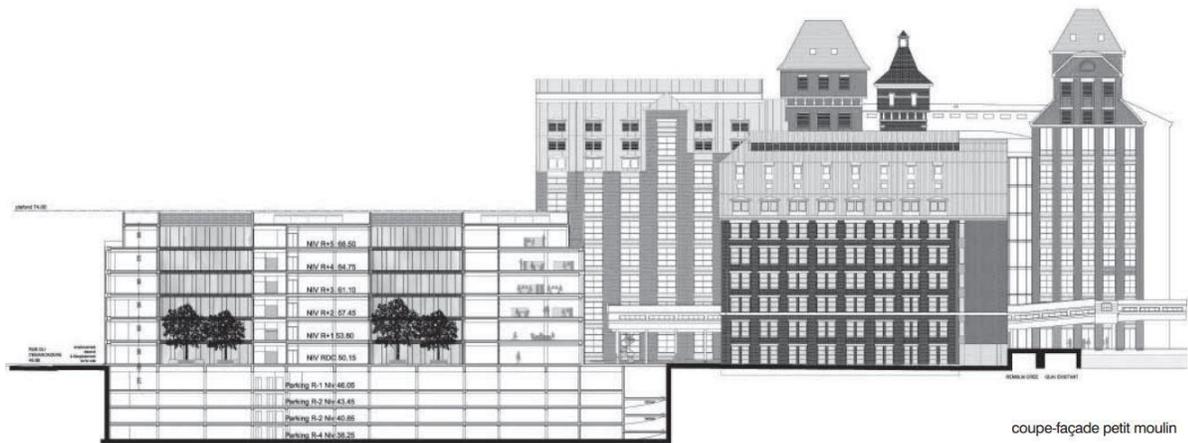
Coupe façade(AA) du petit Moulin avec en arrière-plan les façades des bâtiments conservés .
